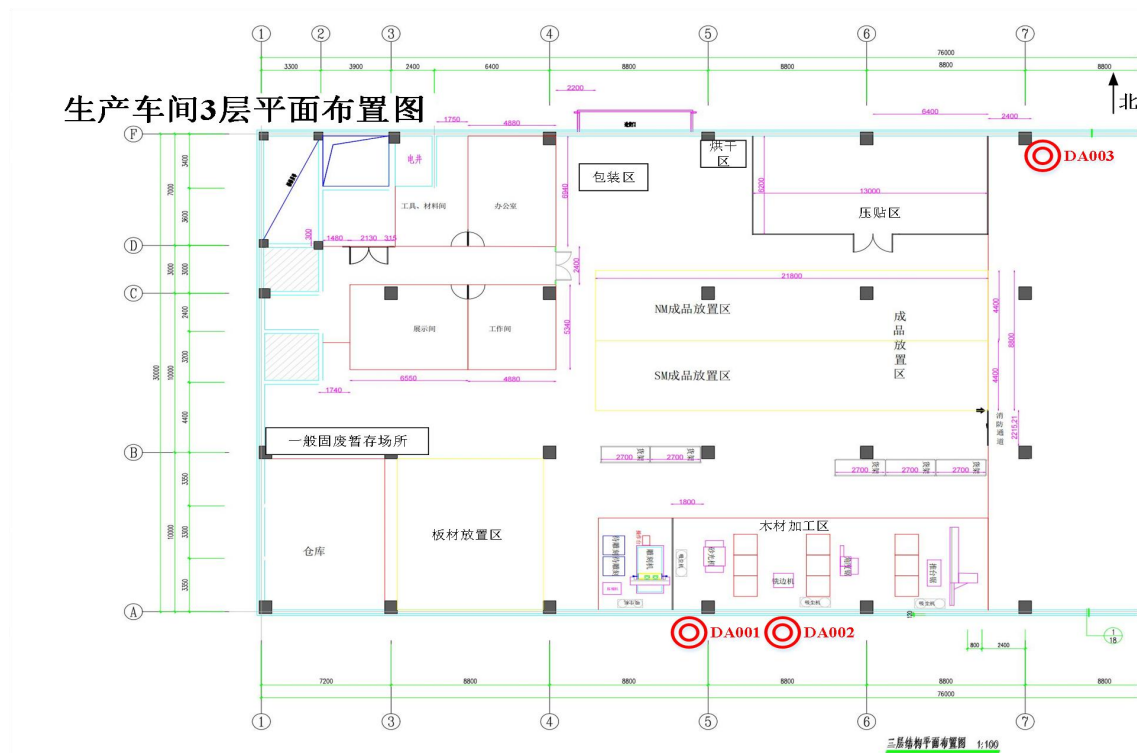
建设项目环评审批生产车间 3 层平面布置图
